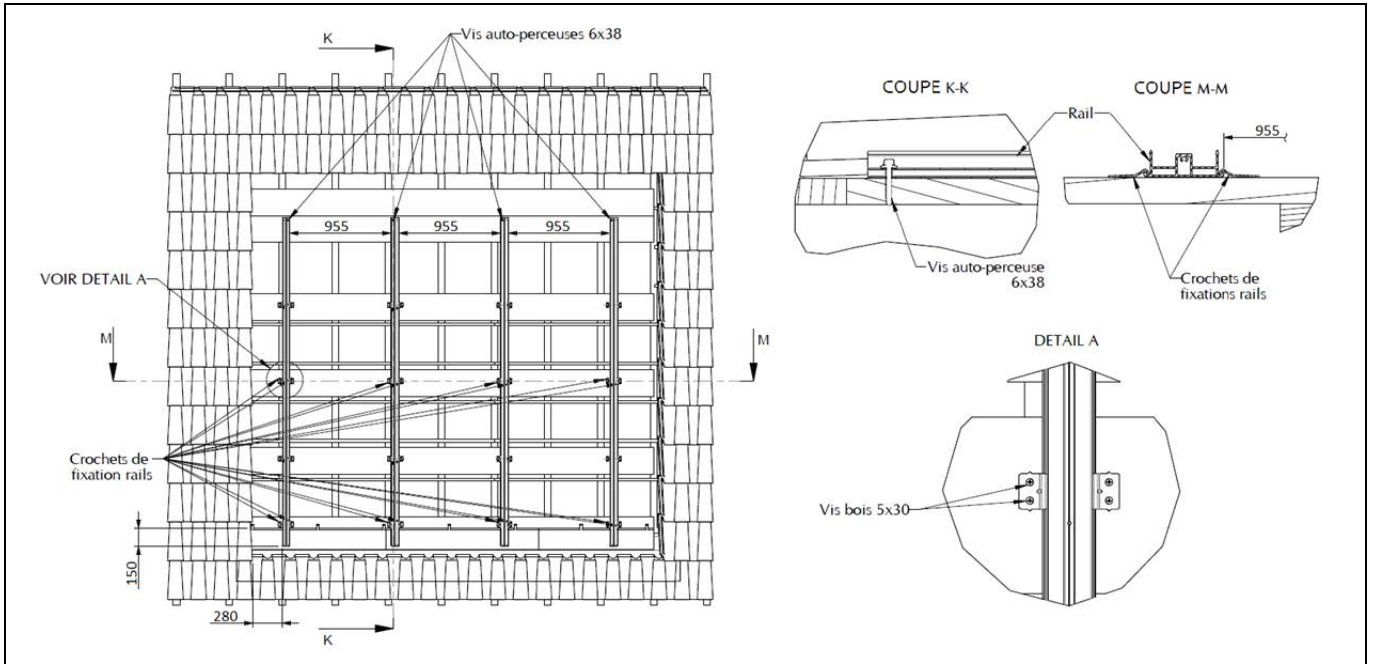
Pose des rails gouttière pour installation sur toiture tuile
